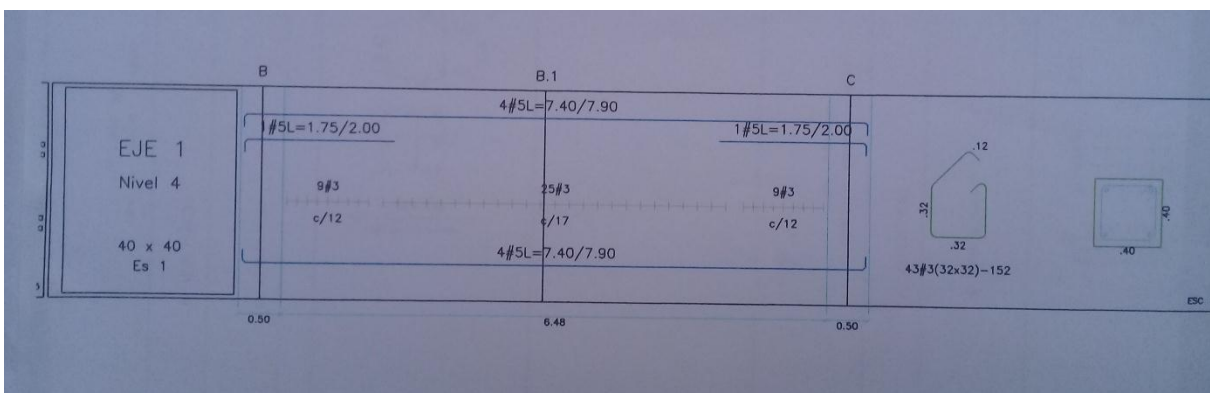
Detalle de armado de acero de Viga aérea nivel 4 eje 1.
